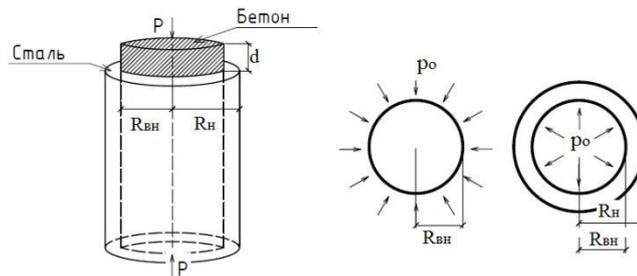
Расчетная схема предварительно напряженной трубобетонной стойки, сечения бетонного ядра и стальной трубы стойки
